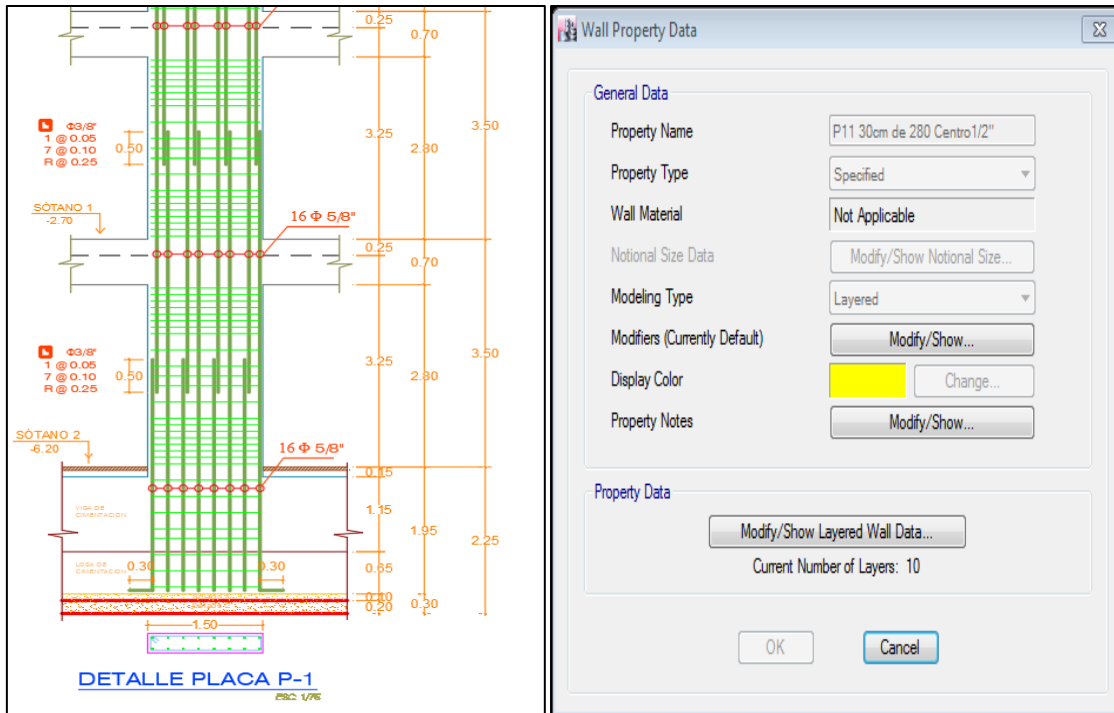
Definición de Secciones Tipo Wall - Muros de Corte
